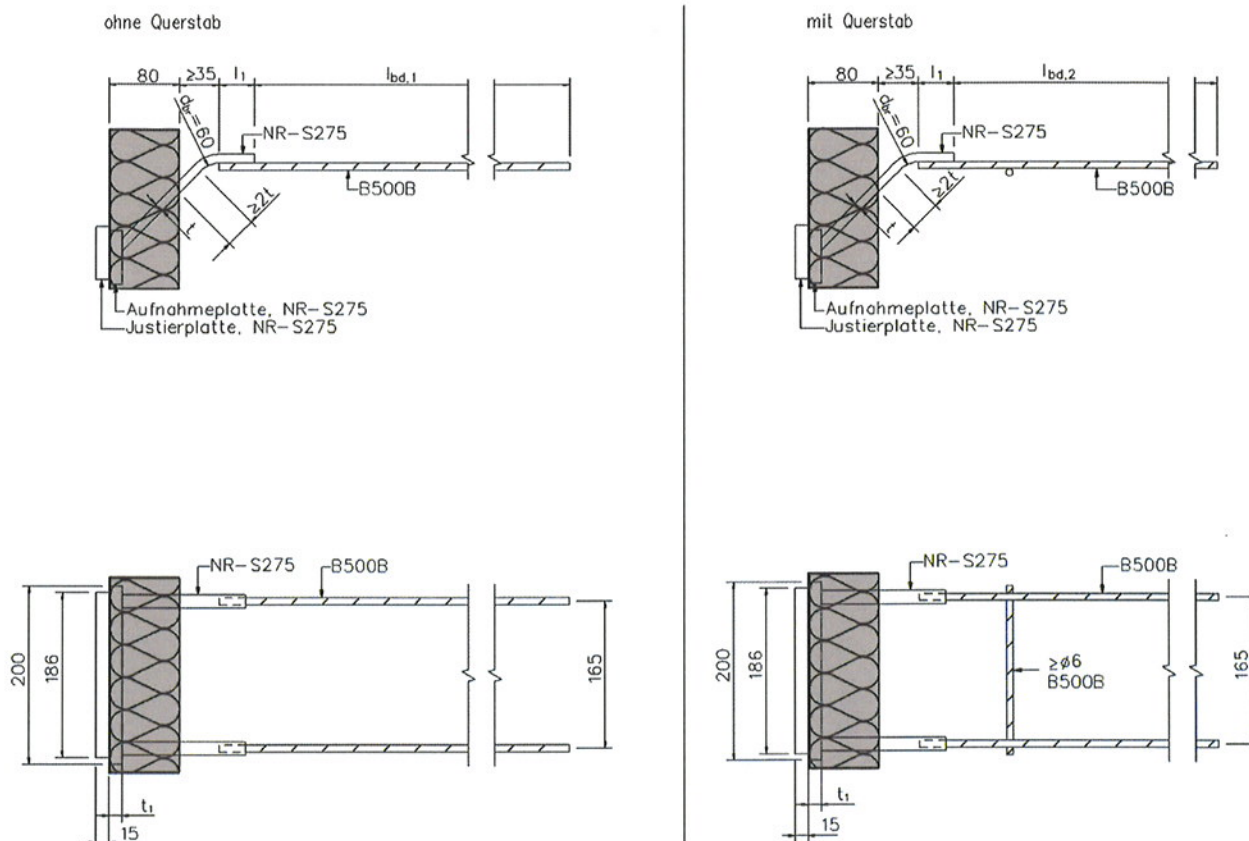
Grundriss Isopro Typ SBM20 Q10 und SBM20 Q12
